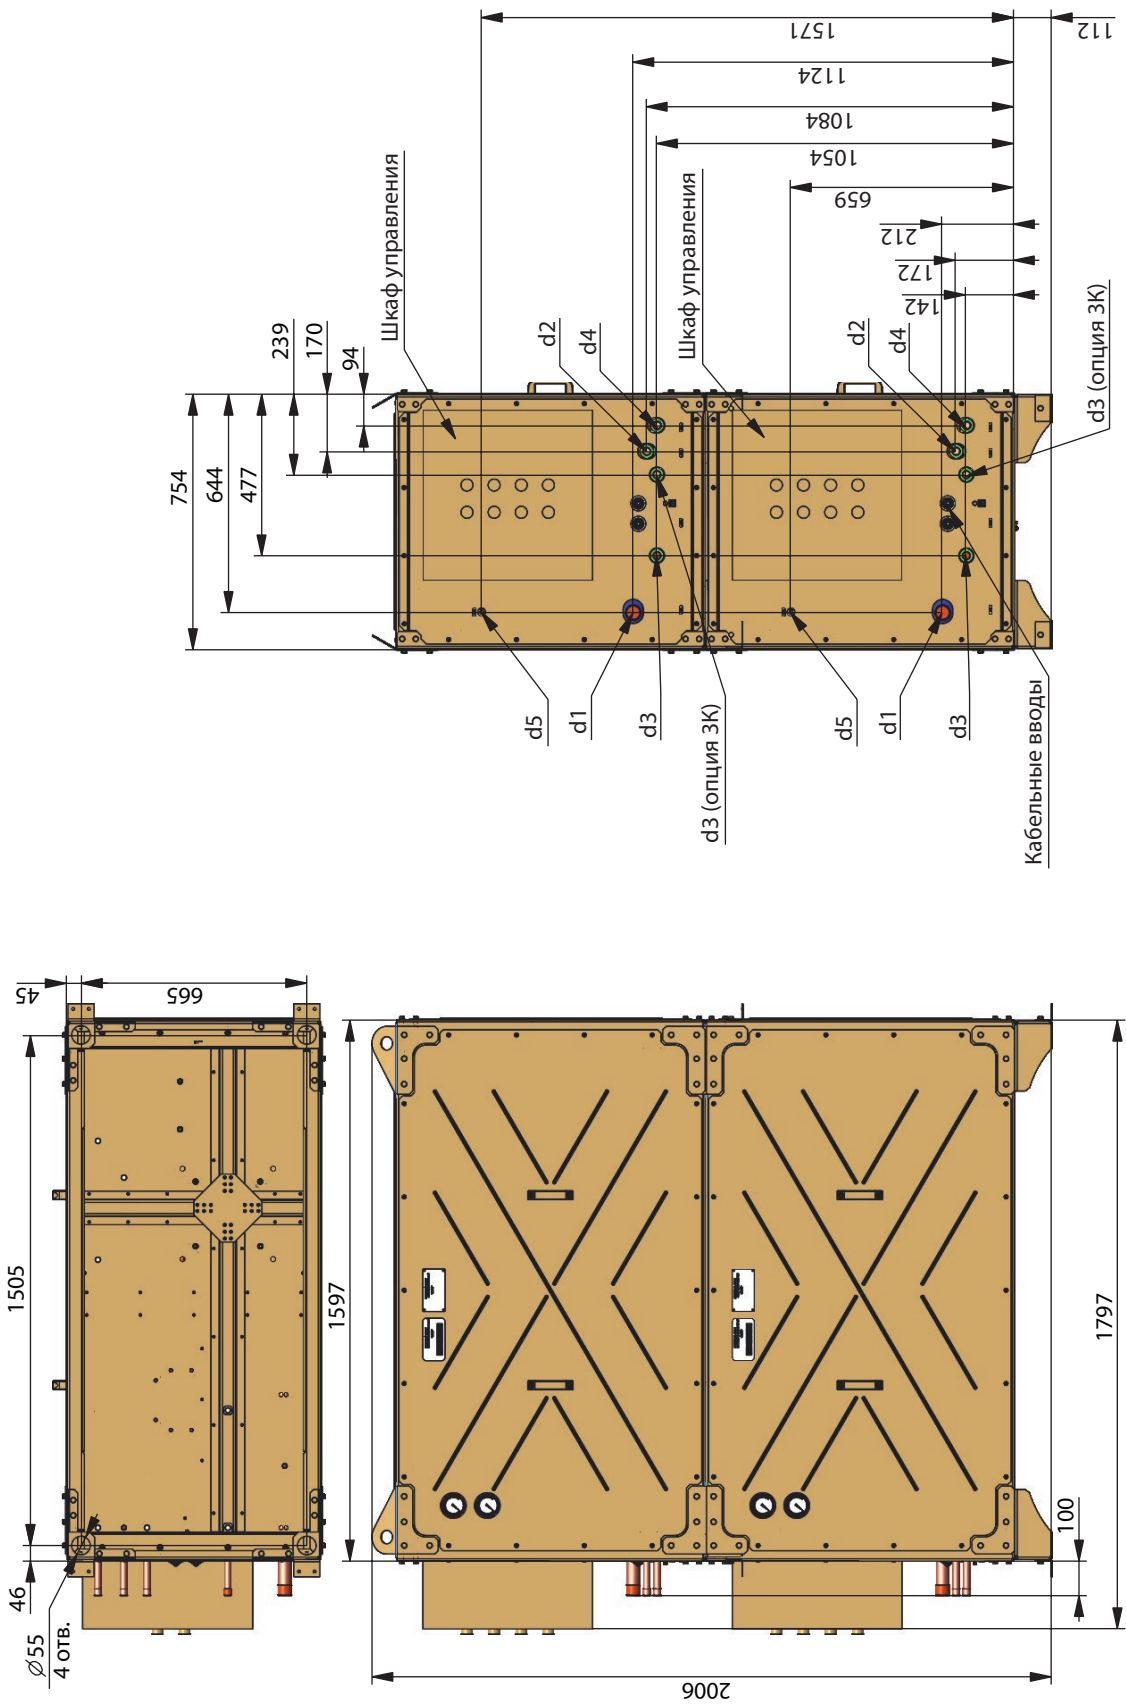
Агрегат компрессорный типа МАРК 100-1252, -1562, -1902
